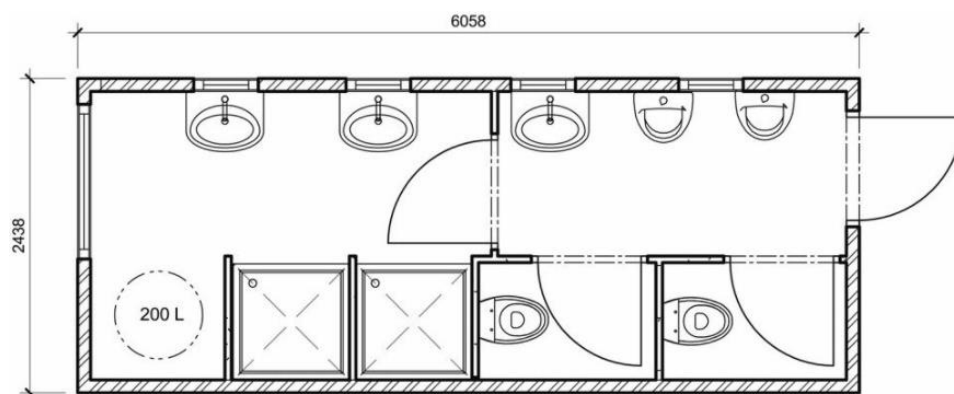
Půdorys stavební buňky Toi Toi BK1 [11]
